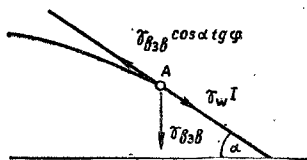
Схема к расчету устойчивости откоса на оплывание
